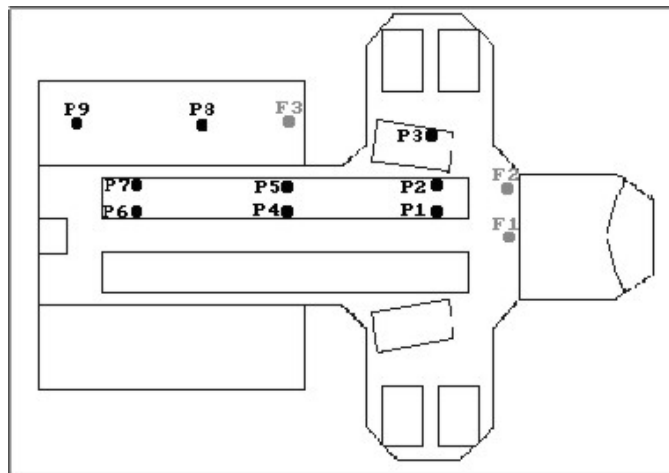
Planta baixa com a localização das fontes (F...) e pontos da medição (P...).
